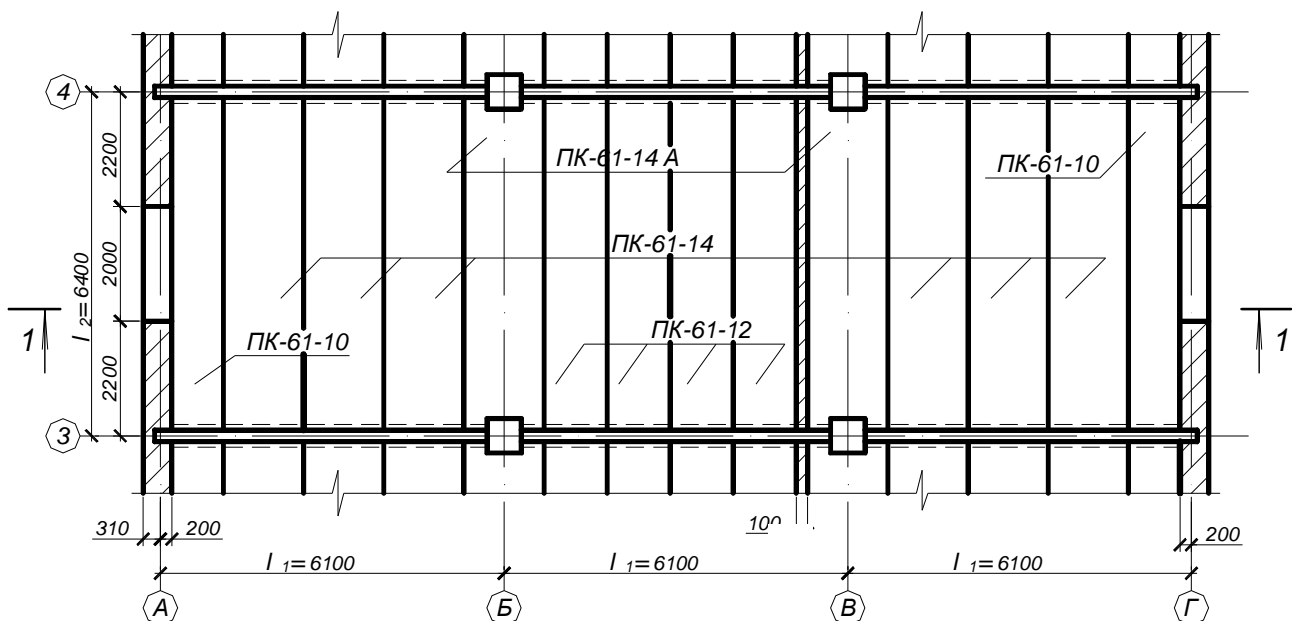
Приклад компоновання збірного перекриття (фрагмент)
